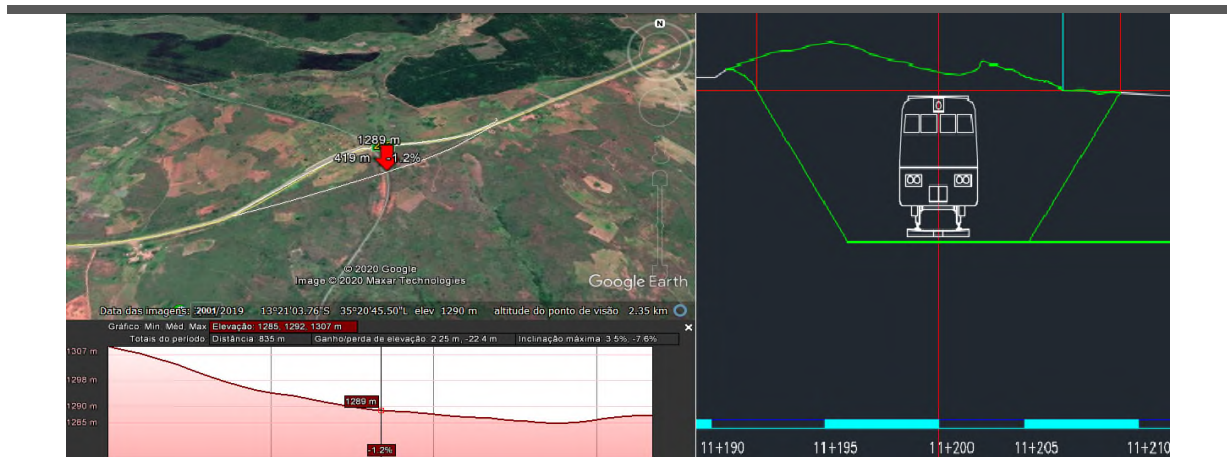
Perfil do local da construção da ponte. (Autor)
